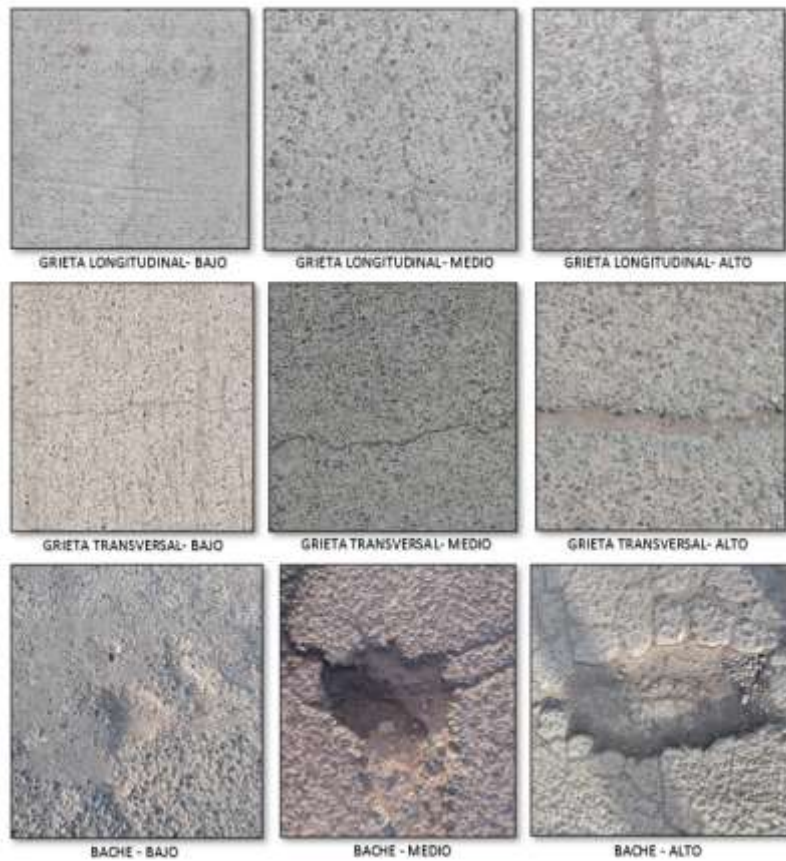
Tipo de falla con su severidad en pavimentos flexibles según MTC
